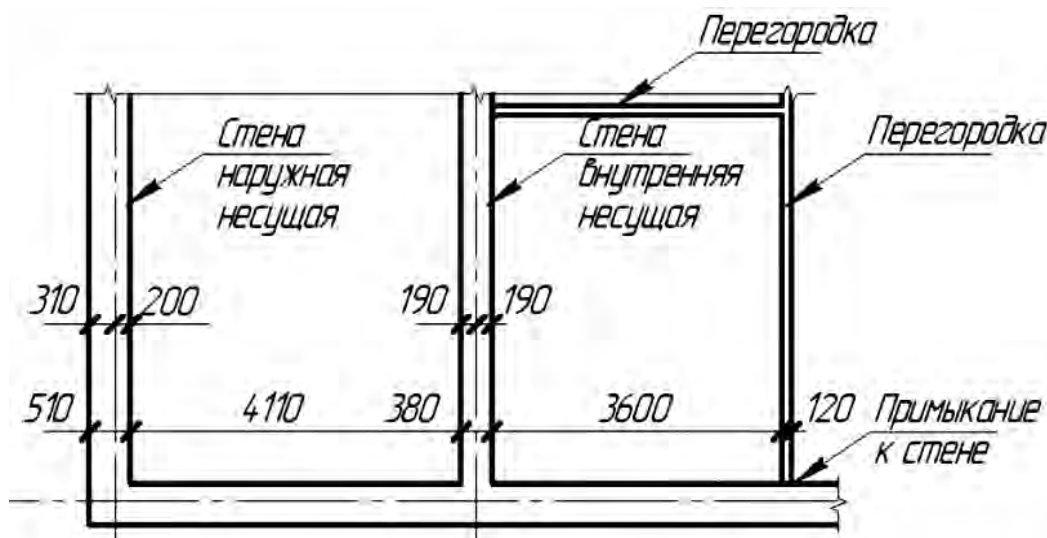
Примыкание капитальных стен и перегородок друг к другу
